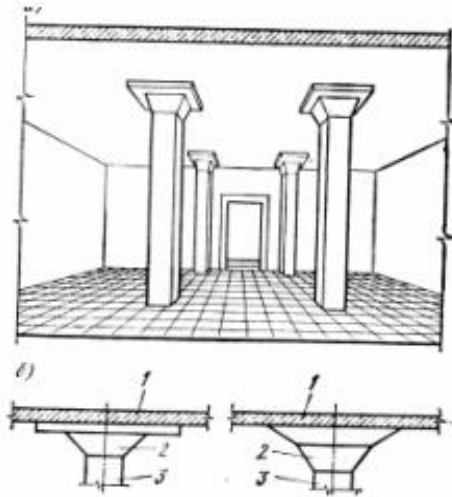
Залізобетонне монолітне безбалочне перекриття:
